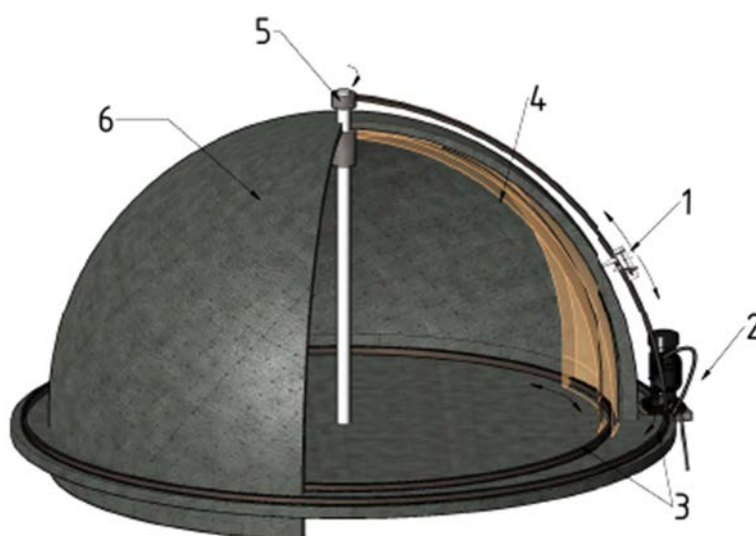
Технология возведения купольного здания: 1 – печатающая головка; 2 – устройство для подачи активированного композиционного материала под давлением; 3 – опорный элемент для передвижения скользящей опалубки и полуарочной направляющей; 4 – скользящая опалубка; 5 – узел соединения полуарки и опорной стойки; 6 – купол
